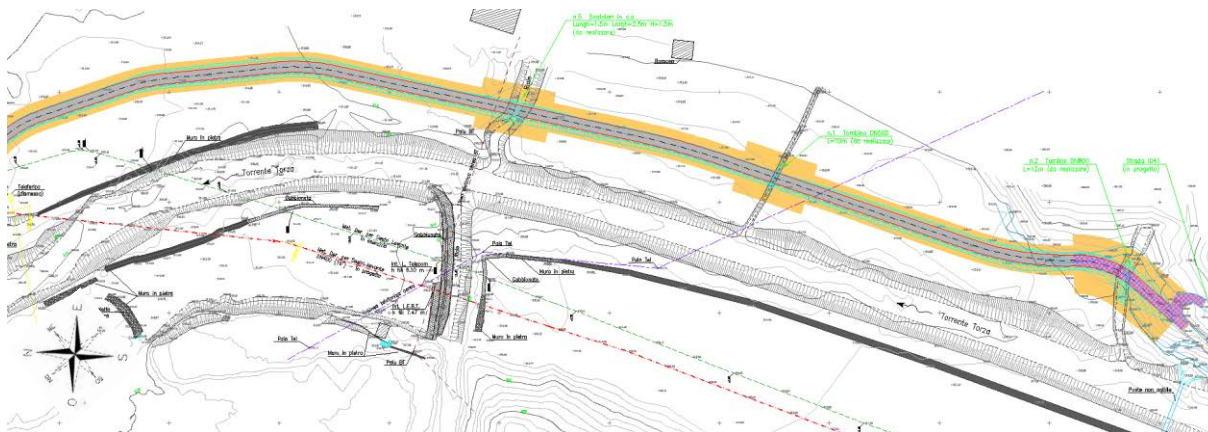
Sviluppo planimetrico della strada di nuova realizzazione ID40 – secondo tratto
